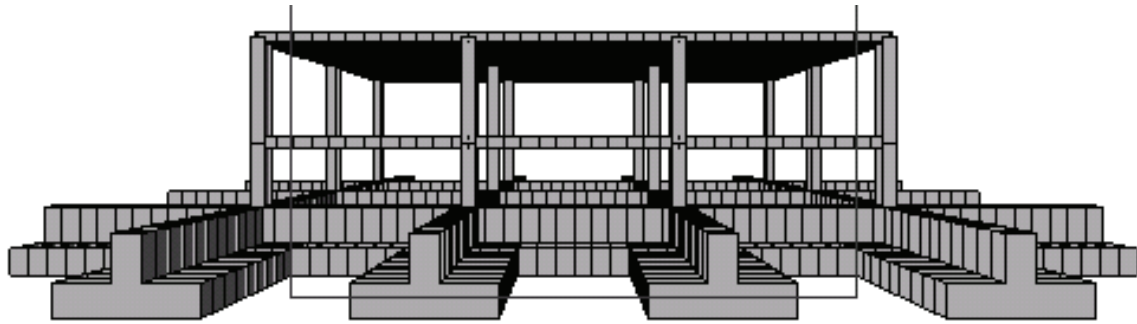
Противокарстовый фундамент в виде перекрестных балок.
